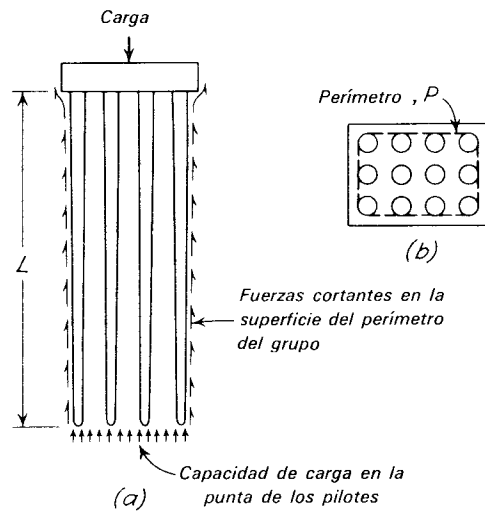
a) Sección y b) planta de un grupo de pilotes apoyados por fricción en arcilla.
